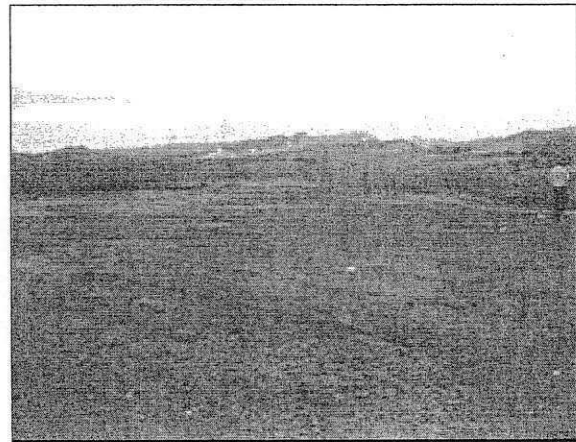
Vista do Terreno onde será construído o Fórum de Igaraci
